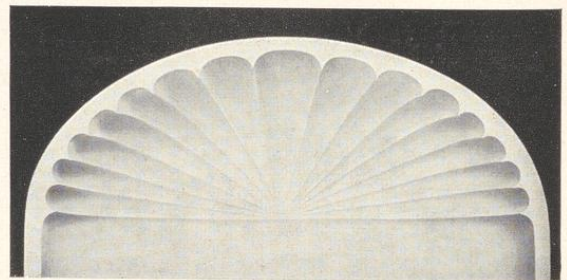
Offenes Schirmgewölbe über elliptischem Grundriß
